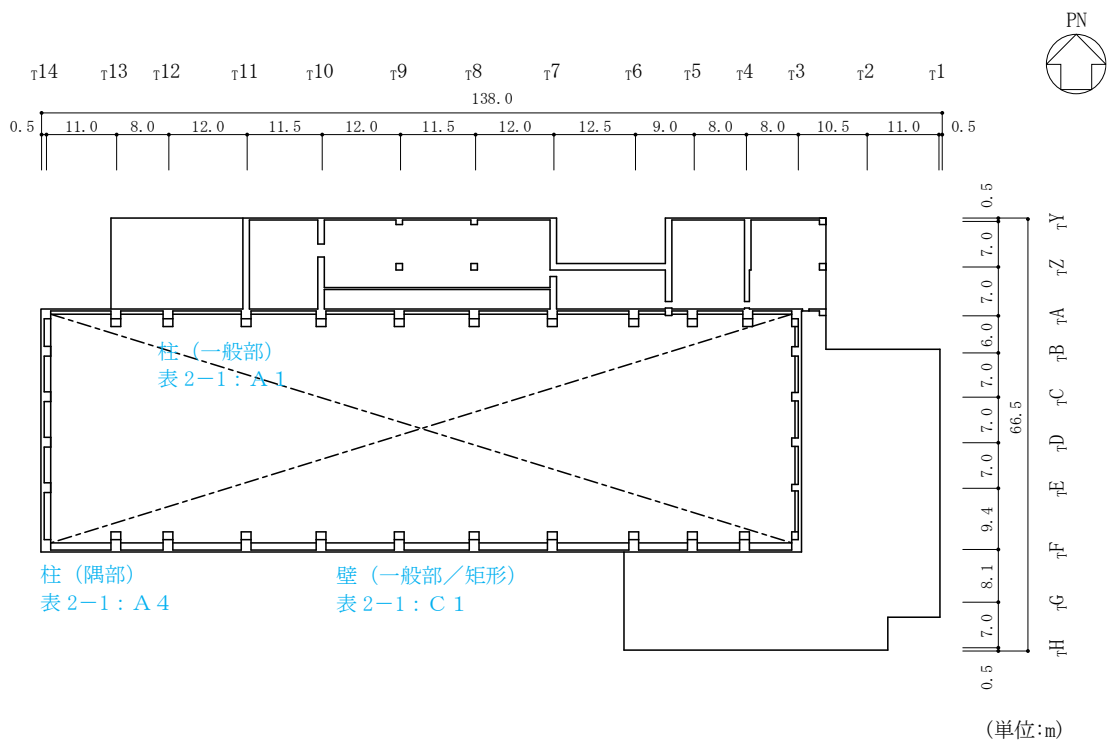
(5) タービン建物の概略平面図 (EL 32.0m)
